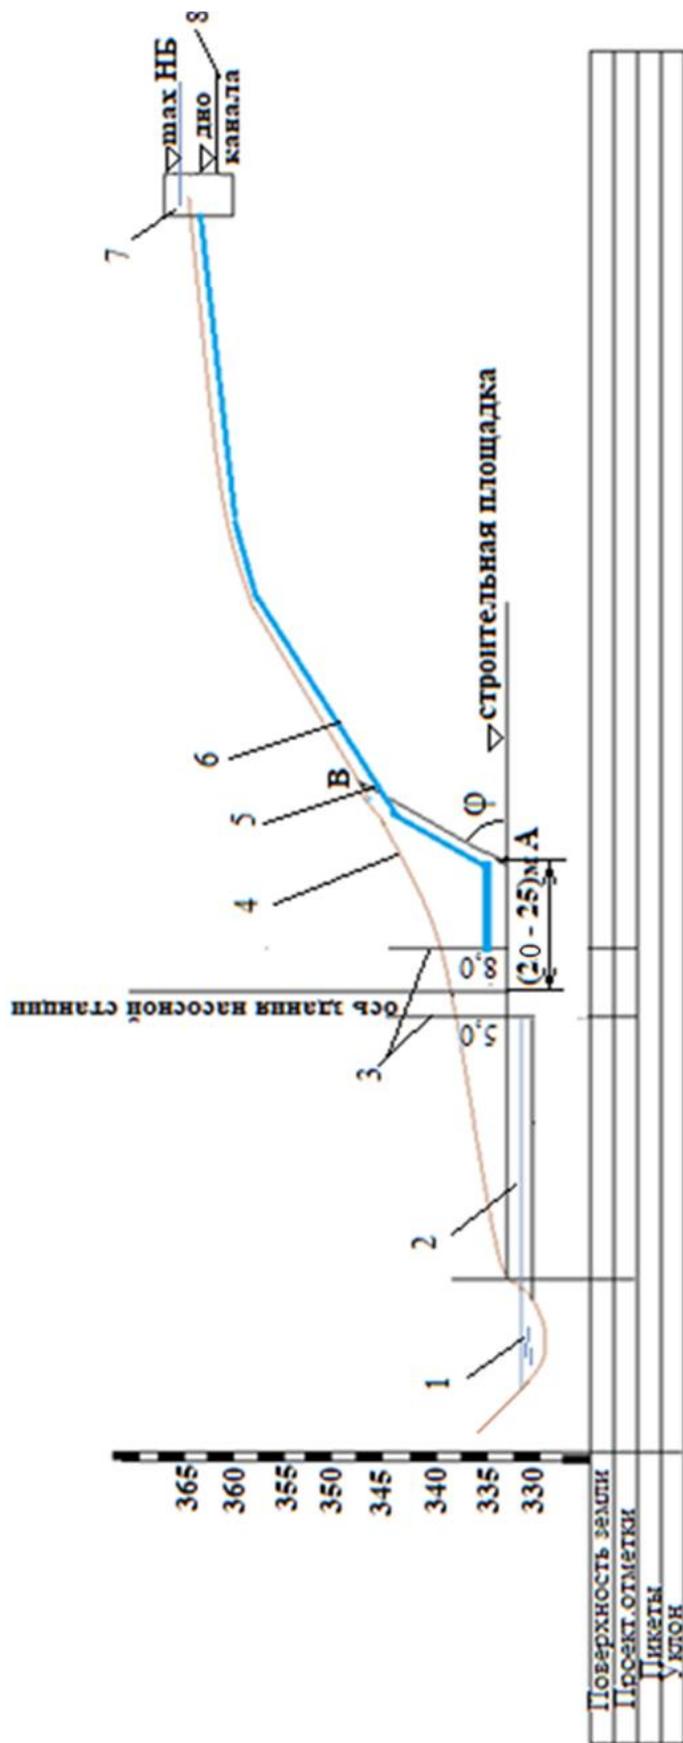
Продольный профиль по трассе напорно-станционного гидроузла: 1 – источник водоснабжения (река); 2 – подводный канал; 3 – зона рационального заглубления строительной площадки насосной станции; 4 – дневная поверхность земли; 5 – откос котлована строительной площадки; 6 – напорный трубопровод, подающий воду от насосной станции к напорному бассейну; 7 – напорный бассейн; 8 – отводящий канал.
